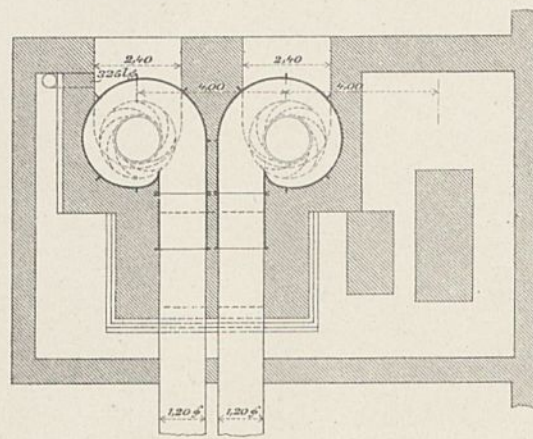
Schnitt durch das Grundmauerwerk des Maschinenhauses und der Pumpen.
